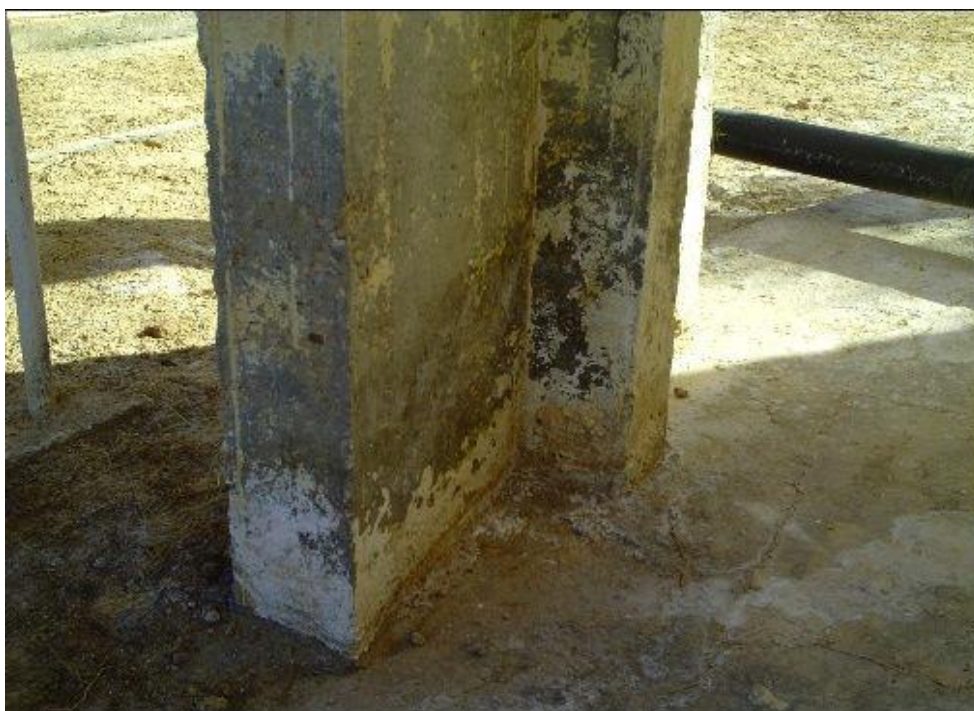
Trace de calcite de couleur blanchâtre et fissurations au niveau de plateforme
